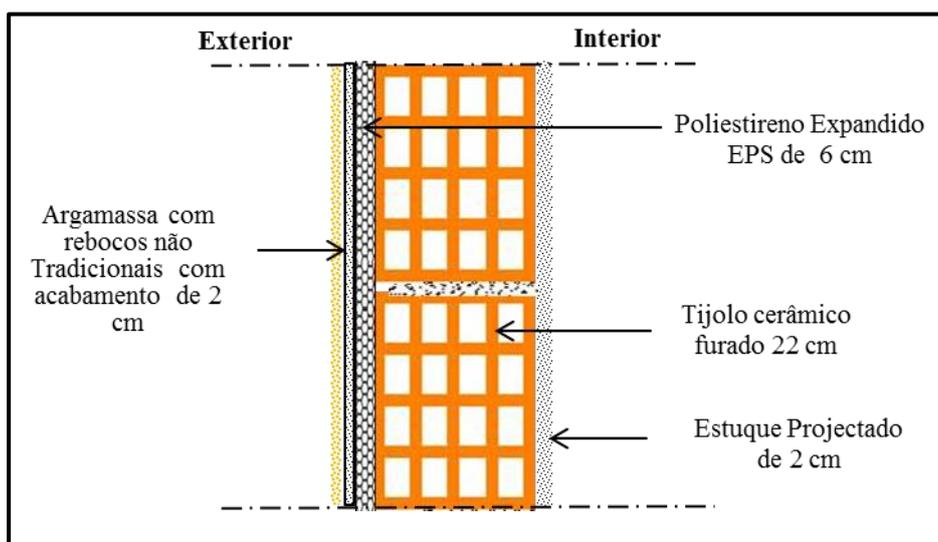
Pormenor Construtivo - PE com isolamento pelo Exterior - EPS
